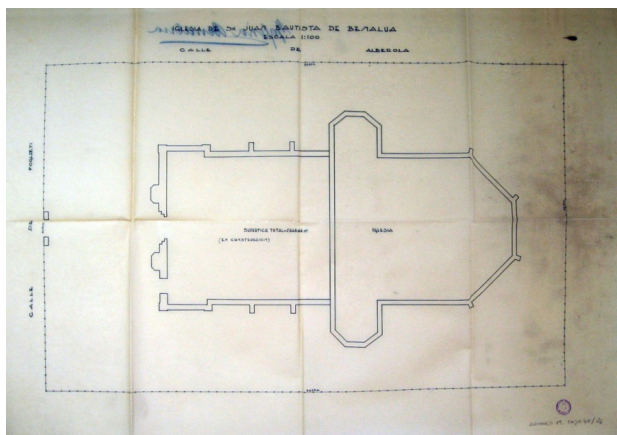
Planta de la Iglesia de San Juan Bautista de Benalúa. 1931. El Templo original (Guardiola, 1889) se designa como Iglesia; la zona anterior -en construcción- se refiere al proyecto posterior de Vidal (1923). Escala 1:100. Fuente: AMA.
